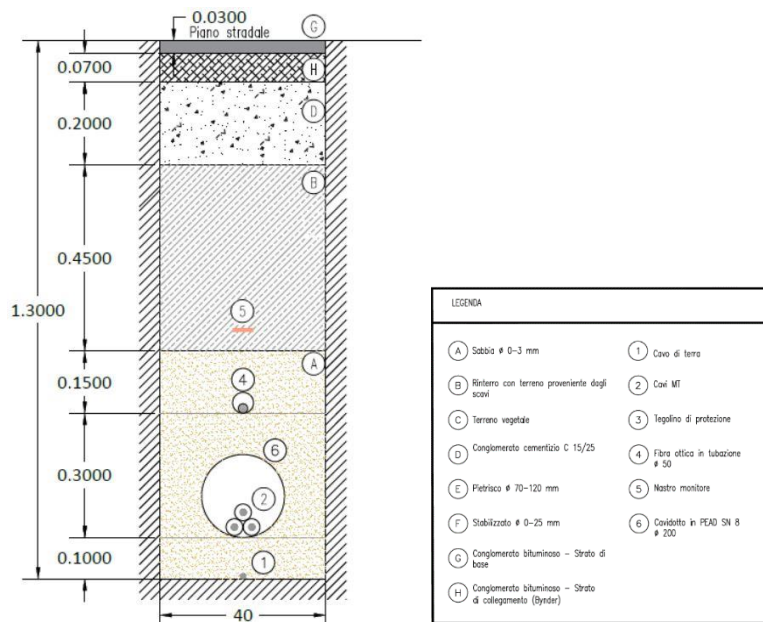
Sezione tipo del cavidotto su viabilità di progetto
